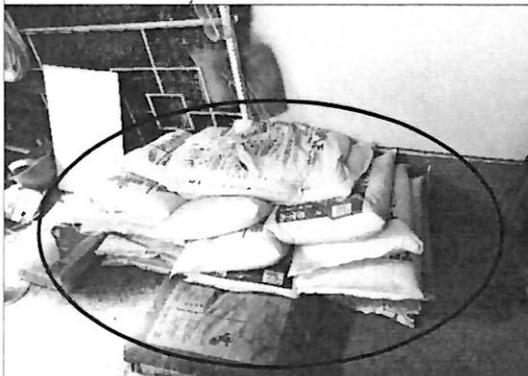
Existencia de bolsas de pinturas y cemento en el piso, ubicadas en la parte posterior de la ejecución de la construcción.
